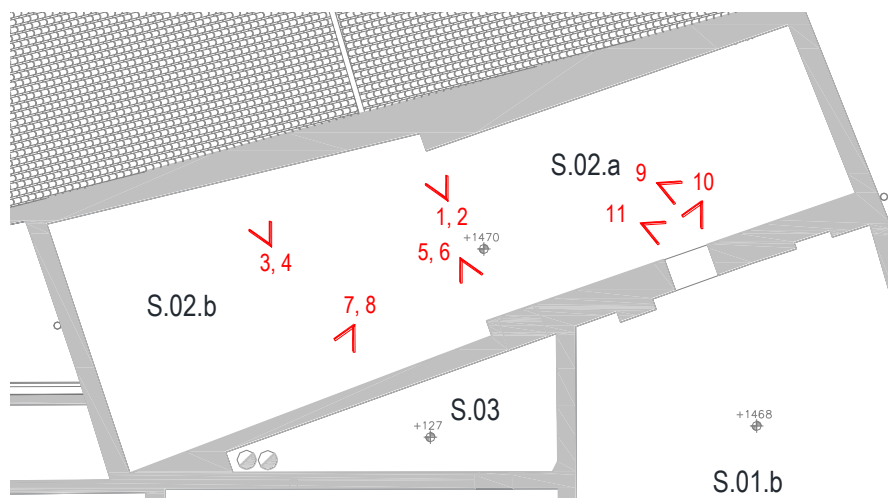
localizzazione delle foto nella pianta del sottotetto
